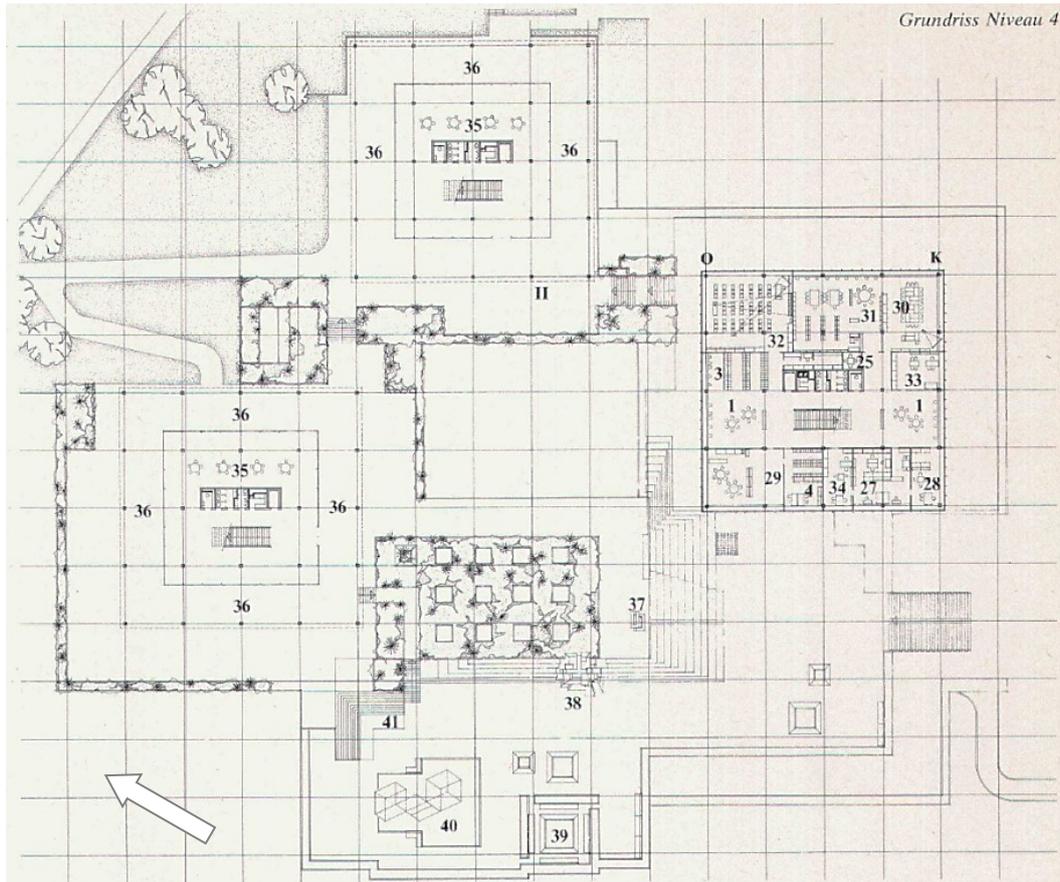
Grundriss Niveau 4 mit dem Hochplateau (Werk, Heft 7/8, 1976, S. 499)
